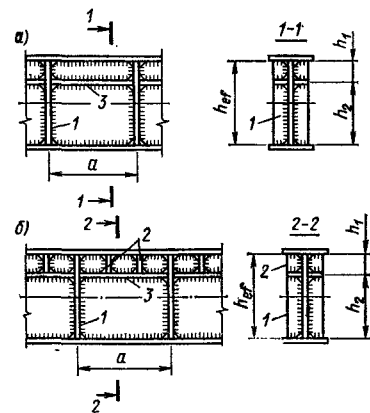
Фрагменты балок, укрепленных поперечными основными ребрами и дополнительным продольным ребром (а, б)
